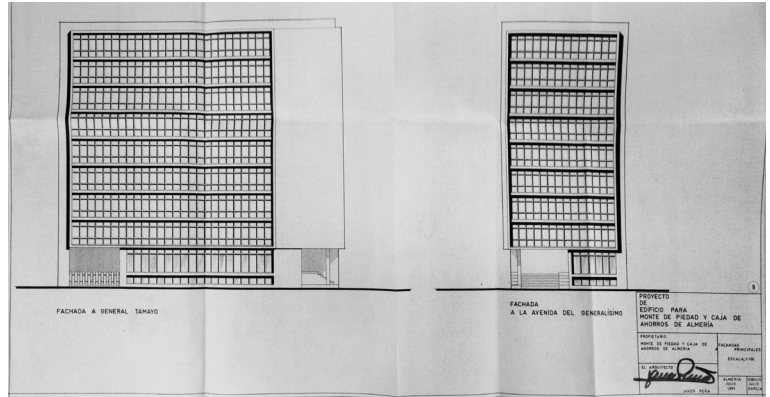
Secciones del proyecto de Edificio para Sede de la Caja de Ahorros de Almería. Plano: Archivo Municipal de Almería Expte. 323/65.
